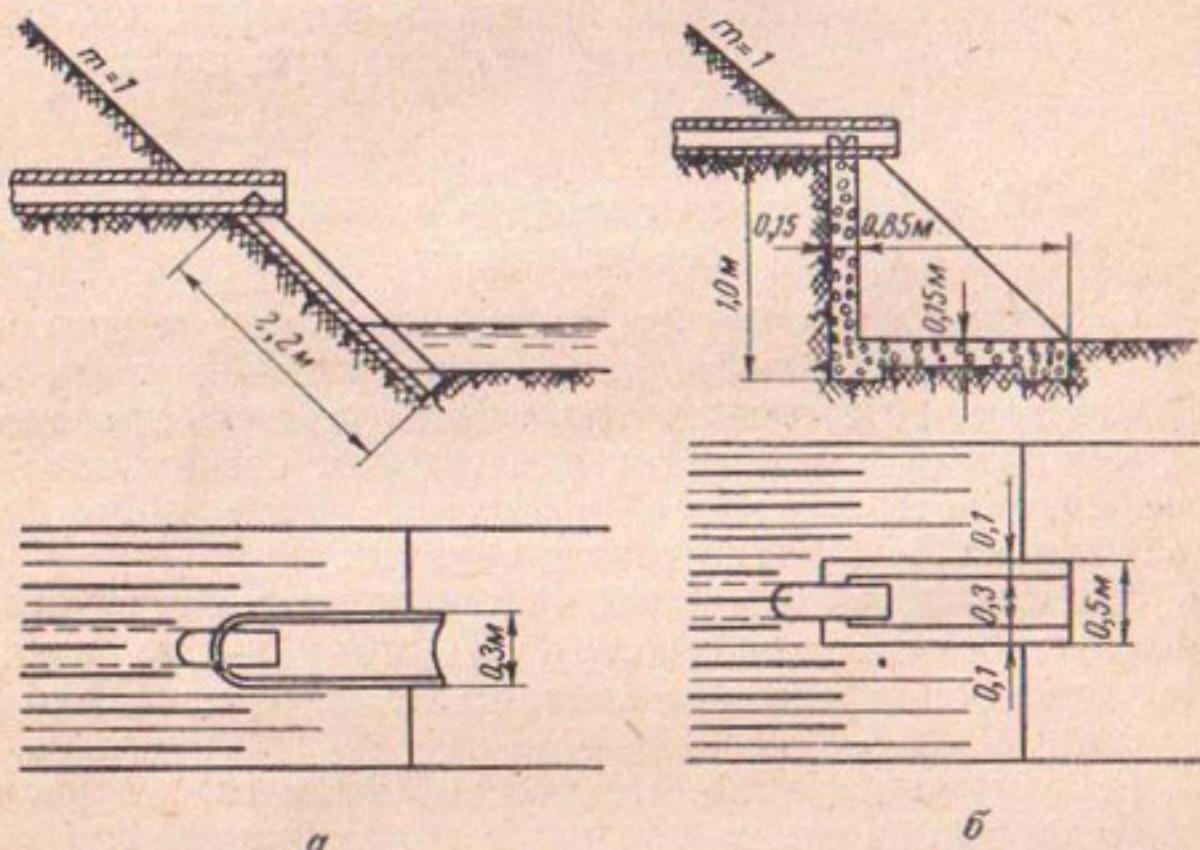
Устьевая часть дрены: а — лотковая, б — бетонная
